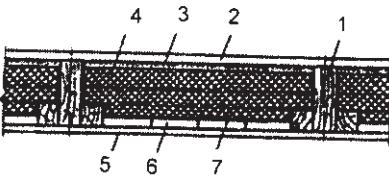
Чердачное перекрытие из деревянных балок и щитов наката
